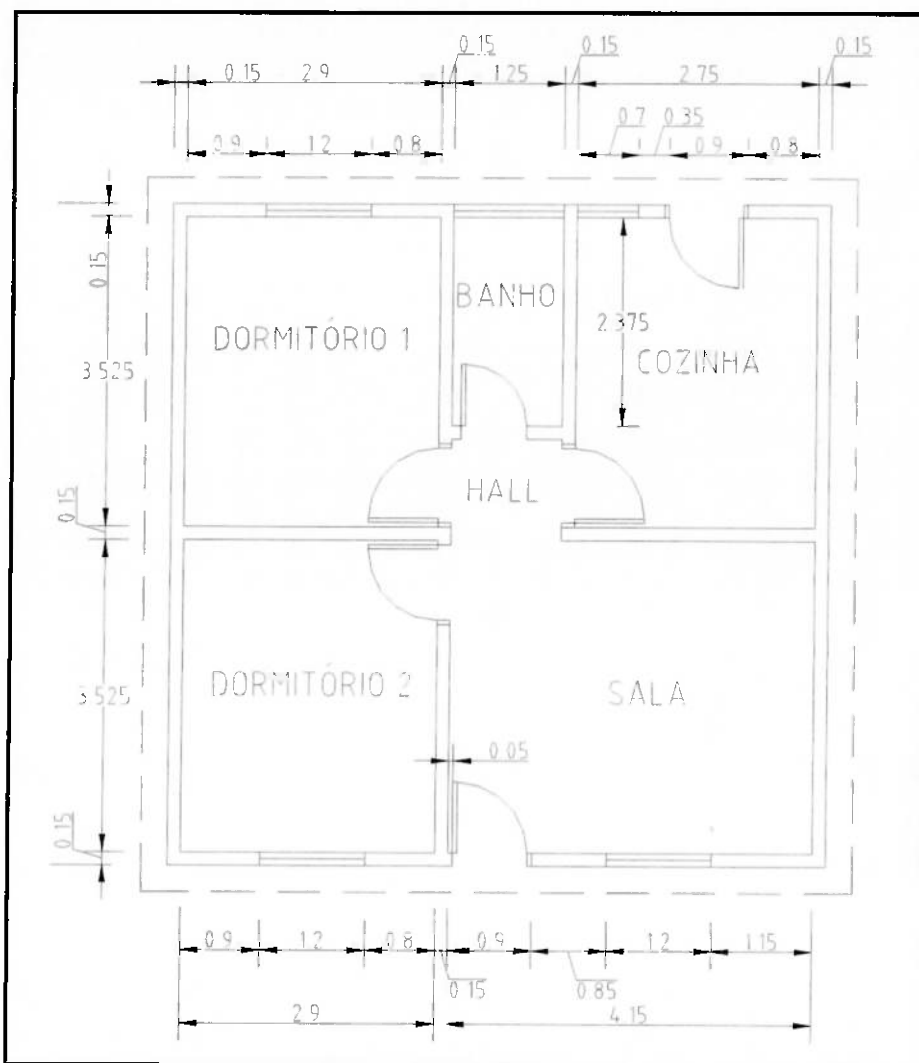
Planta baixa do Protótipo Popular. AKUTSU (1983).
